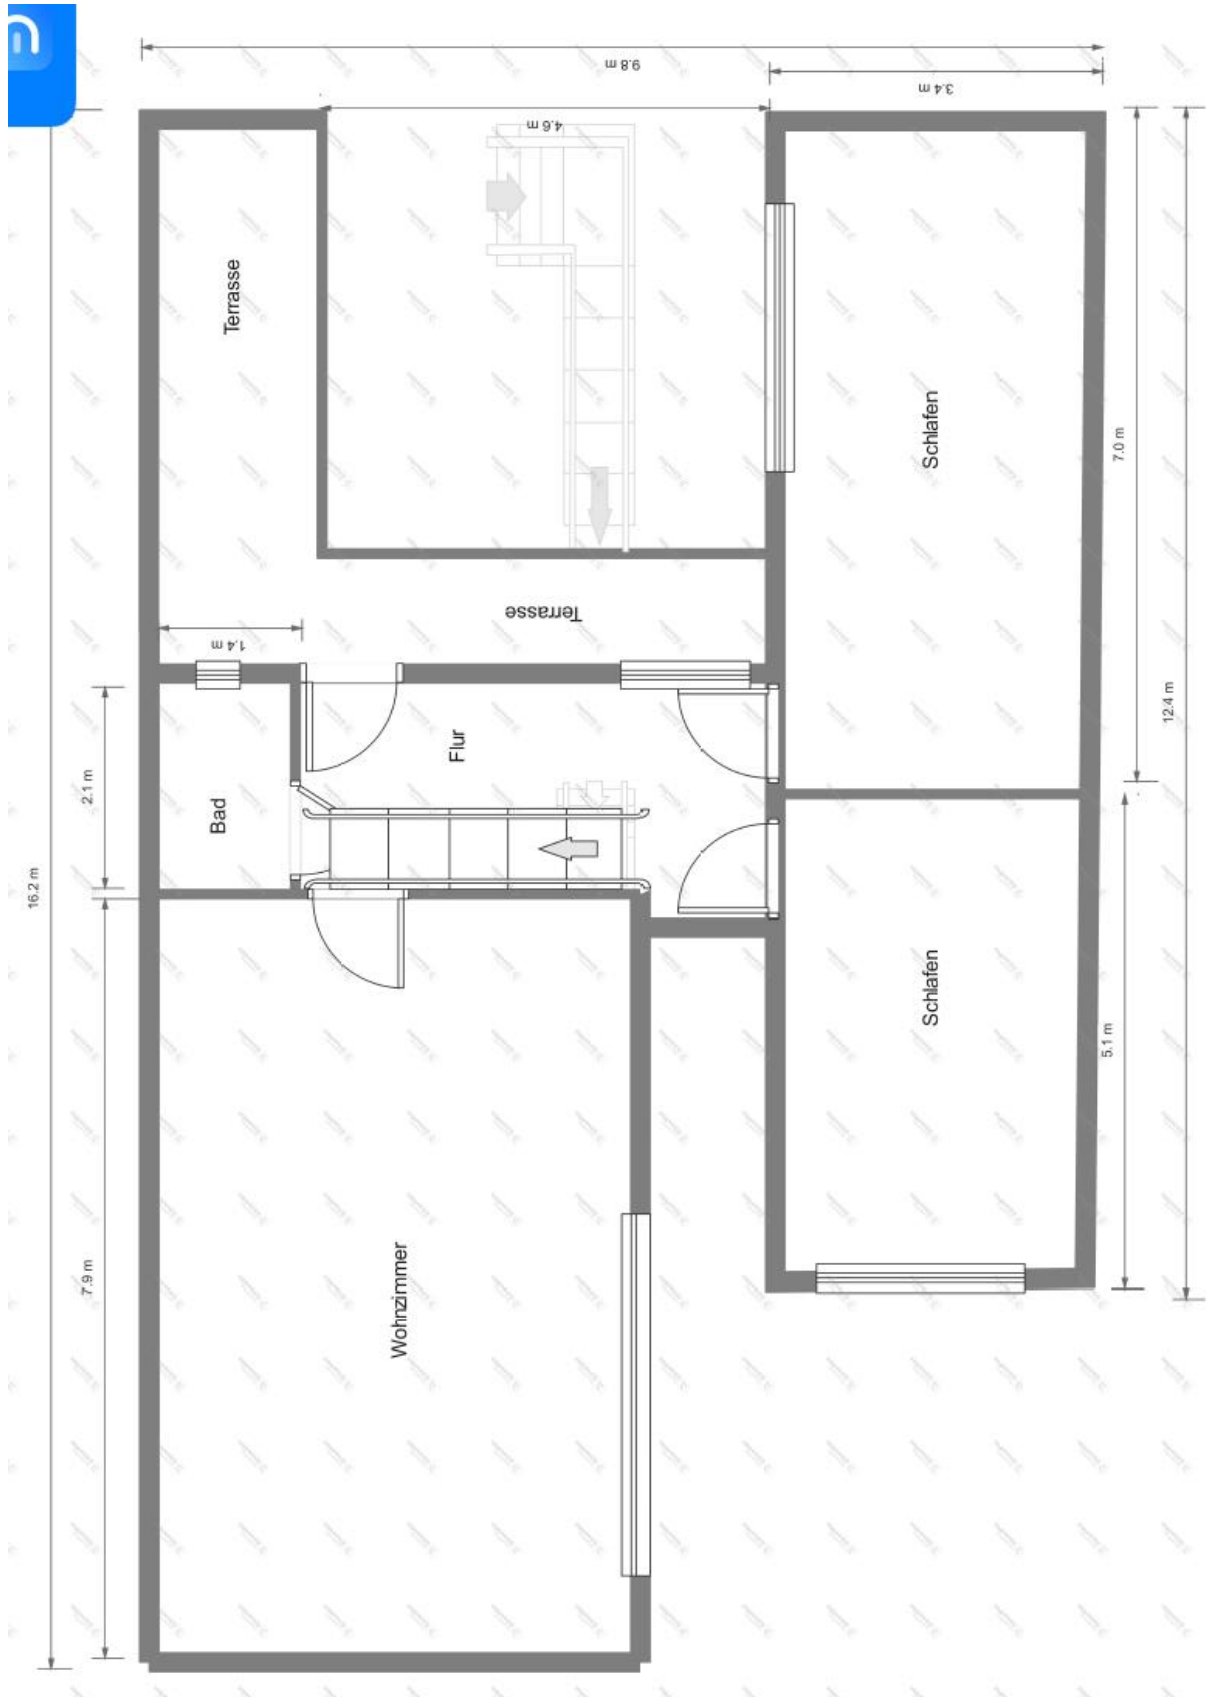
Grundriss OG, nicht maßstabsgetreu, Maße ohne Gewähr
